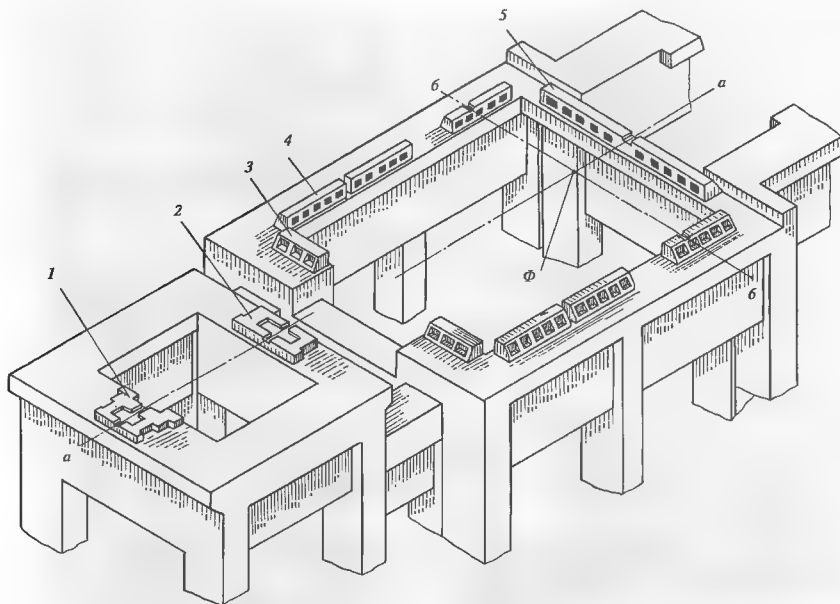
Установка фундаментных рам под турбину на верхней фундаментной плите
